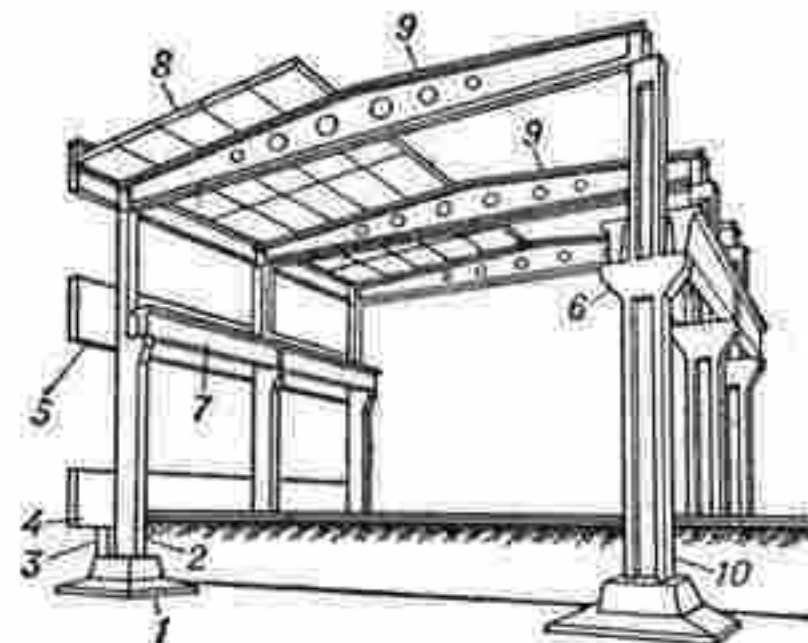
Схема одноэтажного промышленного здания с железобетонным каркасом: 1 — фундаменты под внутренние колонны; 2 — колонны наружного ряда; 3 — подкладка; 4 — фундаментная балка; 5 — стеновые плиты; 6 — консоли колонн; 7 — подкрановая балка; 8 — плиты покрытия; 9 — балки покрытия; 10 — внутренние колонны.
